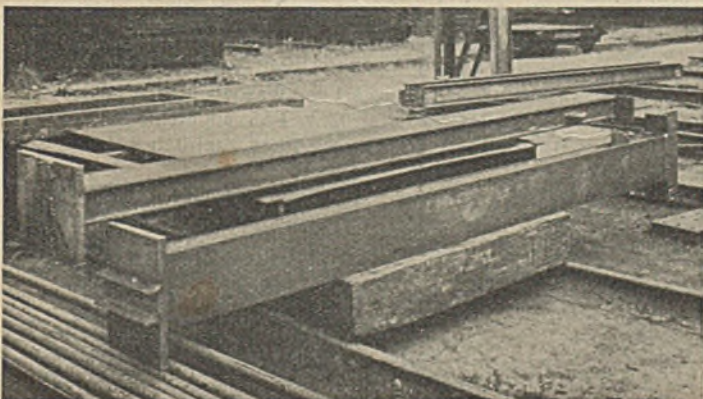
Vollständig geschweißte Stützen „c“.
